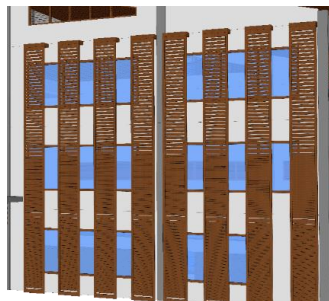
Penerapan Struktur Bentang Lebar pada Bangunan
